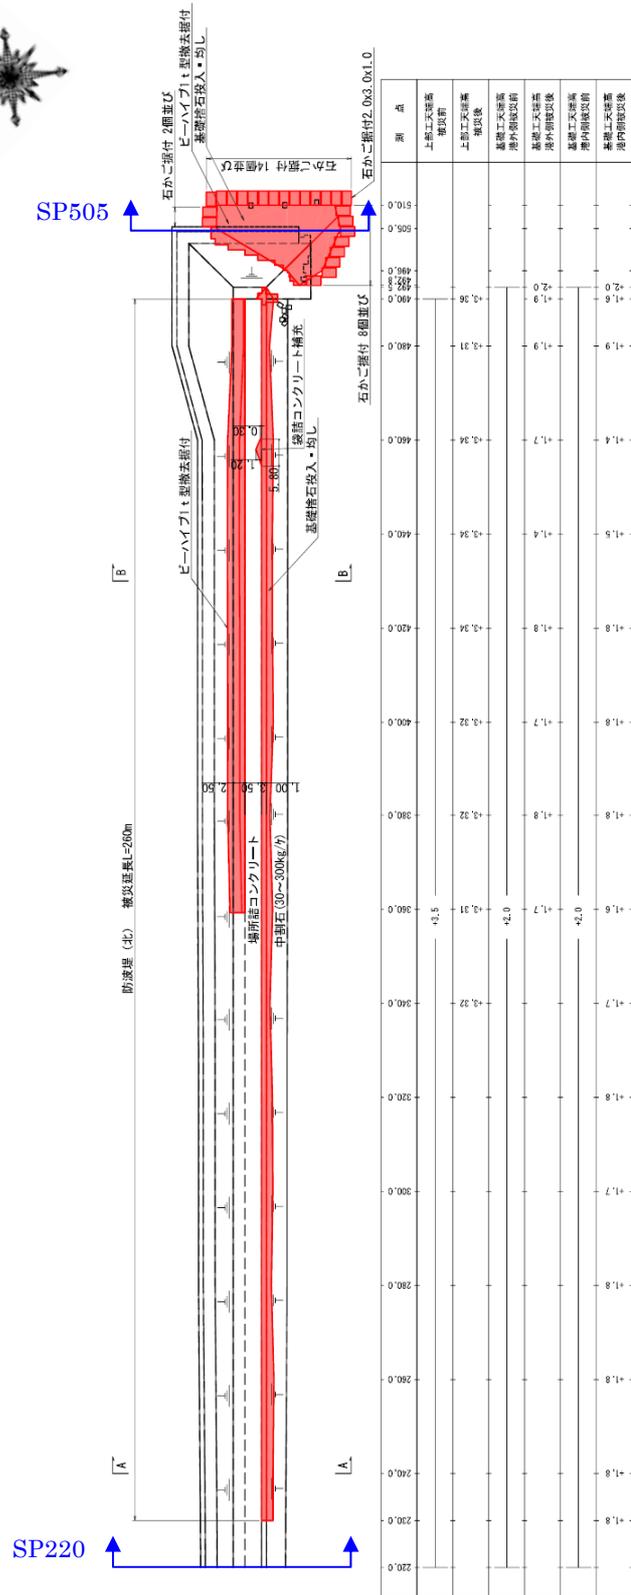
28 No. 5 北防波堤の平面図 (復旧後)
